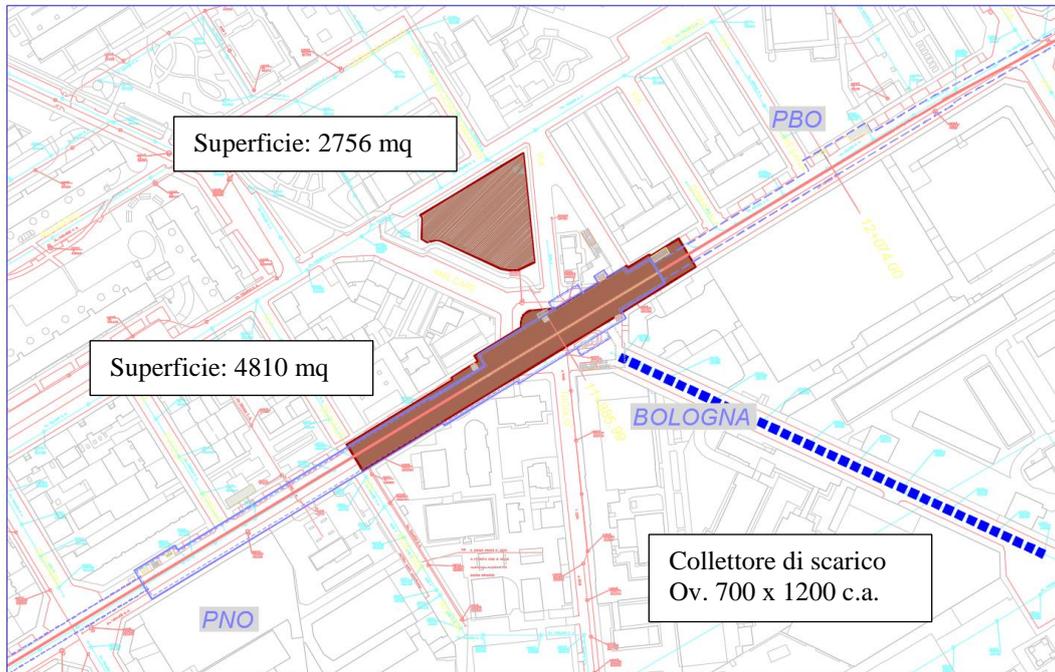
Aree di cantiere – Stazione Bologna – FASE 1
